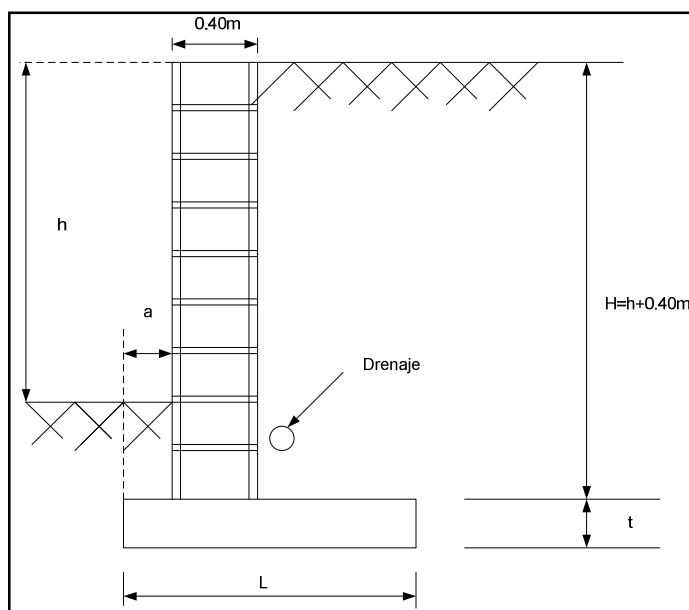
Esquema muro de retención de mampostería reforzada de tres y cuatro metros
